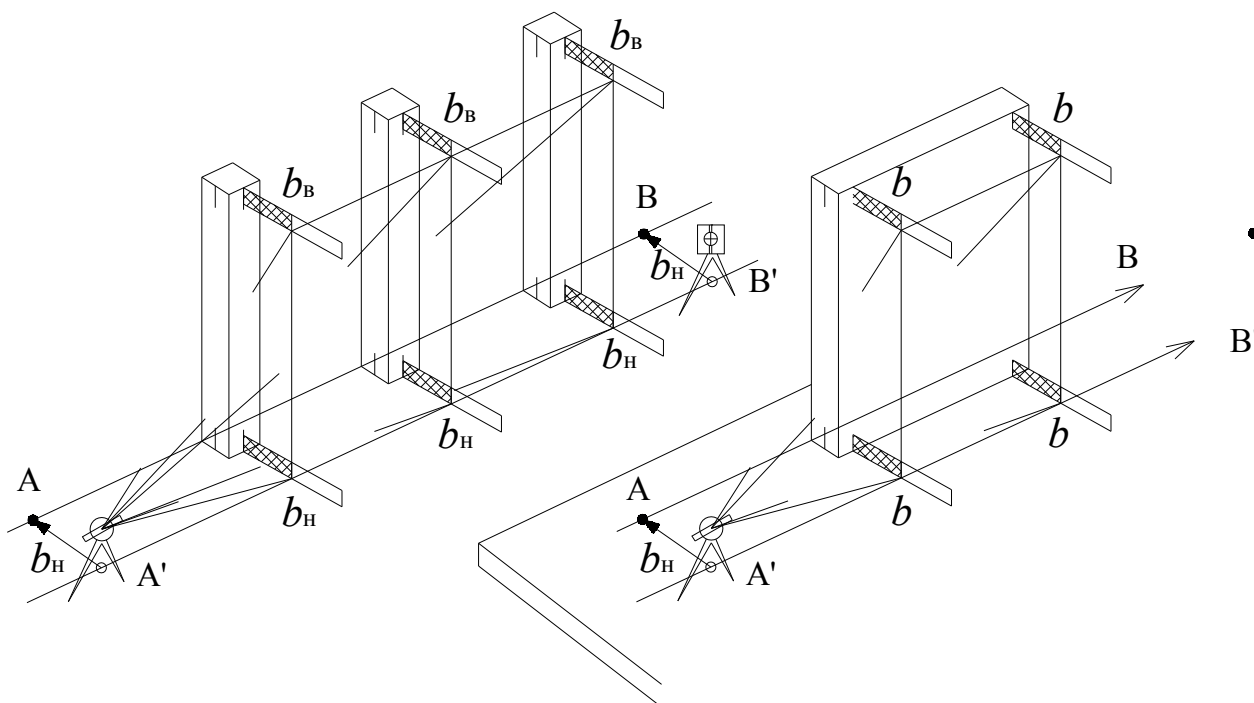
Схема монтажа и выверки конструкций по вертикали способом бокового нивелирования
